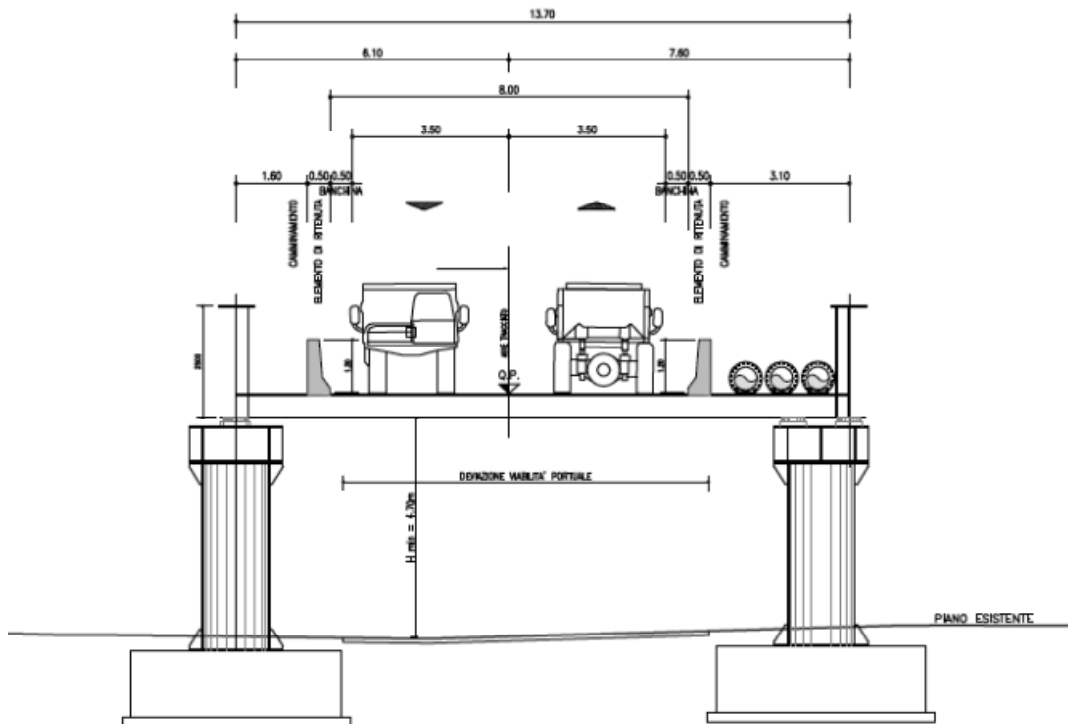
Sezione tipo - Tratto 4 in viadotto acciaio
